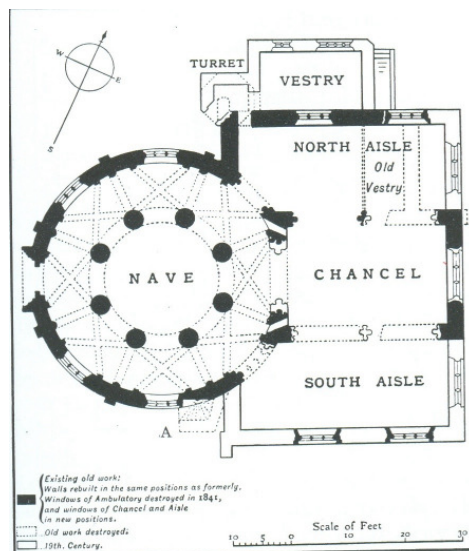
Grundriss, Heilig-Grabkirche, Cambridge, zweites Viertel 12. Jh.
